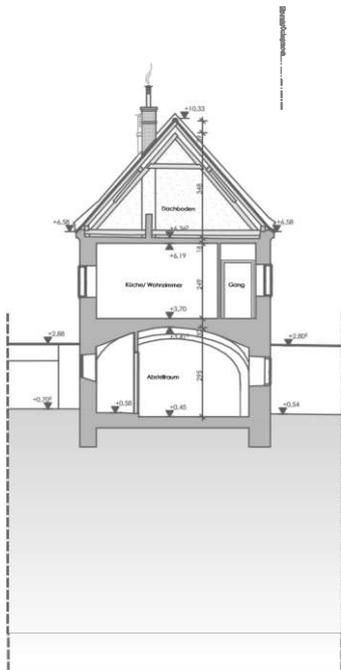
Bestandsplan Schnitt 5-5 M 1:250
